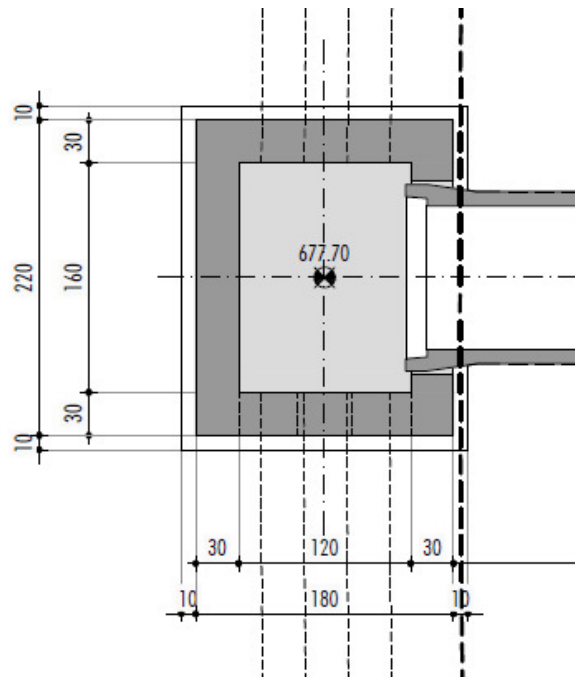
VISTA IN PIANTA DEL MANUFATTO DI IMBOCCO TIPO
